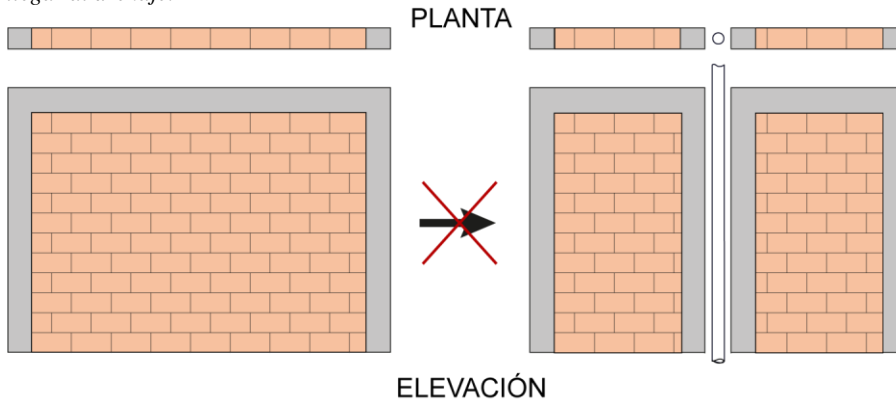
c – División de muros en obra para colocar tubería, no considerada en el proyecto estructural. Los ductos pueden adosarse al muro colocándoles un recubrimiento, por ejemplo, en cocinas, o bien para ductos de drenaje de aguas pluviales o residuales (fig. 10.2.4.6.5).
